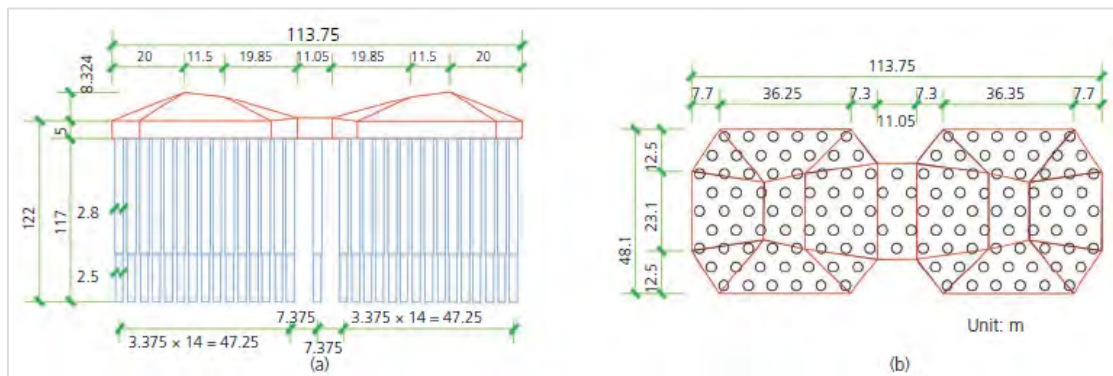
Sutong Yantze River Bridge – Tipica fondazione su pali<sup>146</sup>
